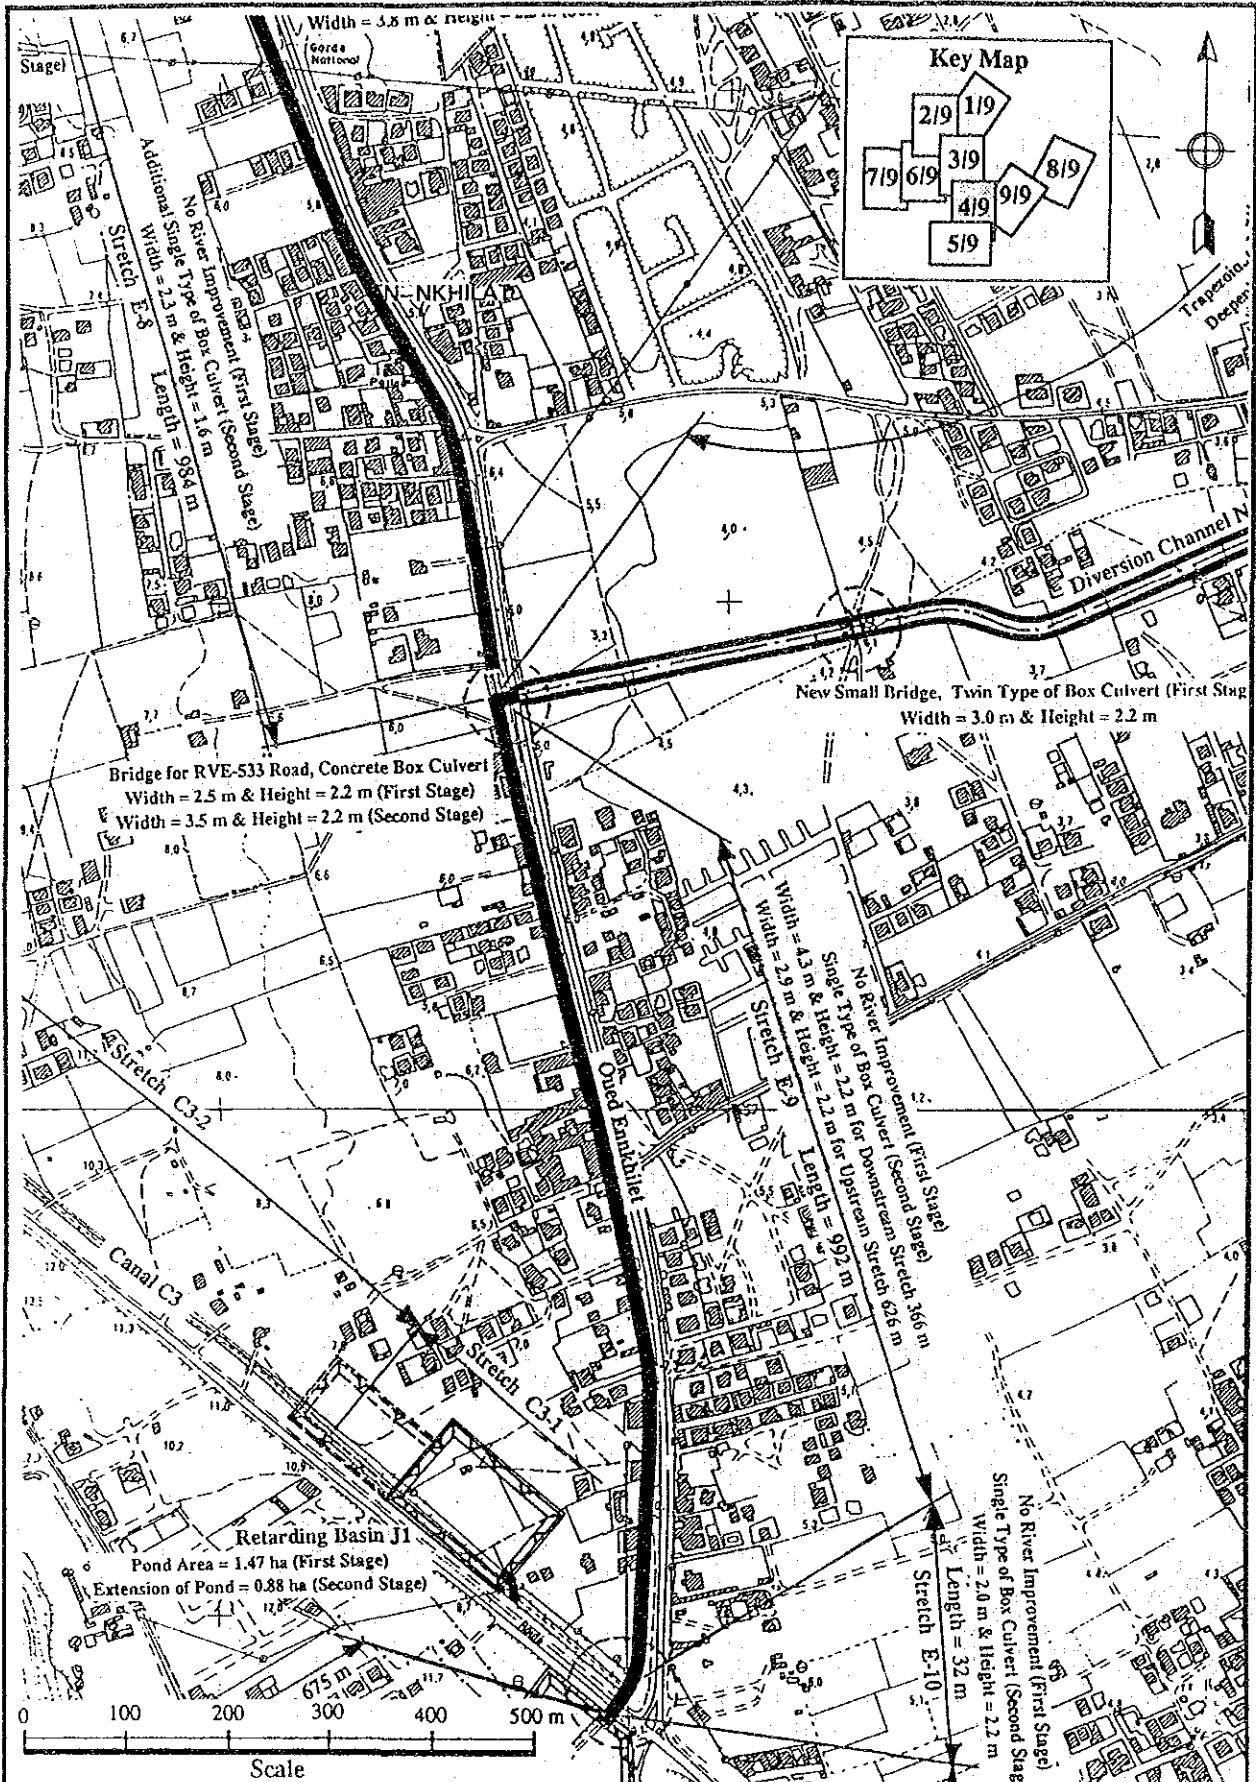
Tracé en plan de la variante d'aménagement de l'Oued Ennkhilet (4/9)
